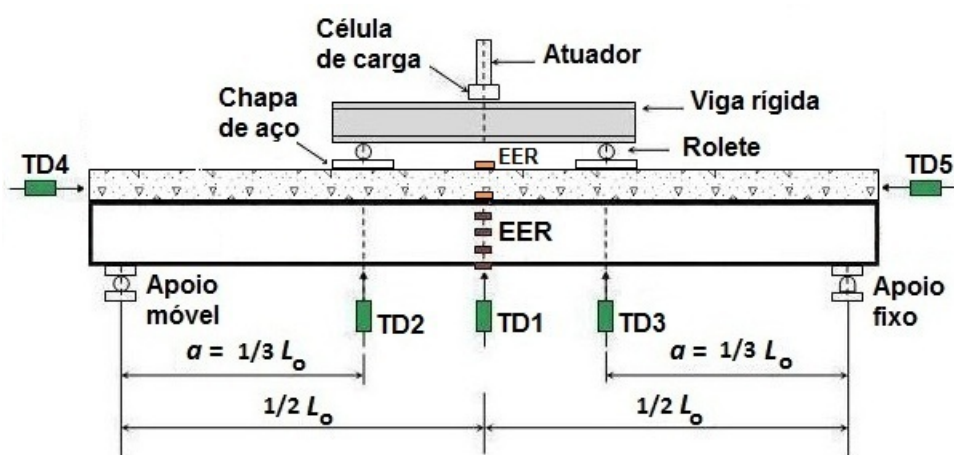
Ensaio de flexão: esquema para as vigas mistas com laje colaborante (protótipos FLX-VM-CL)
